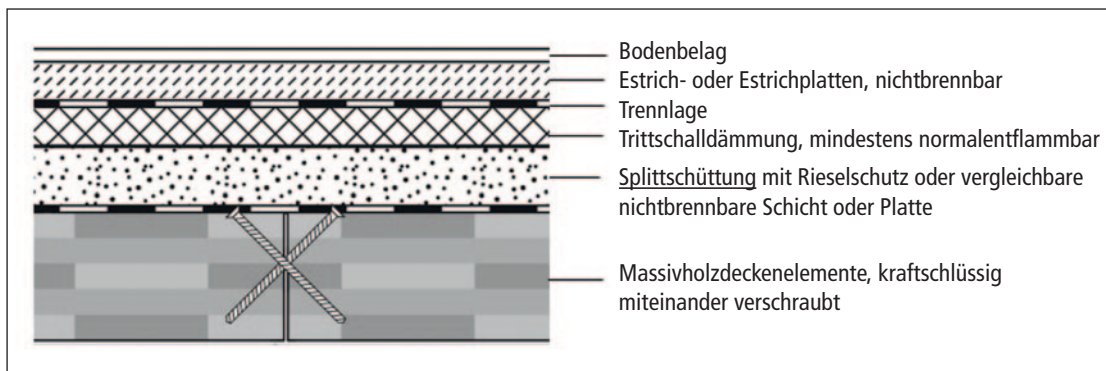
Elementstoß einer unbelagten Massivholzdecke nach M-HolzBauRL Oktober 2020 [2]
